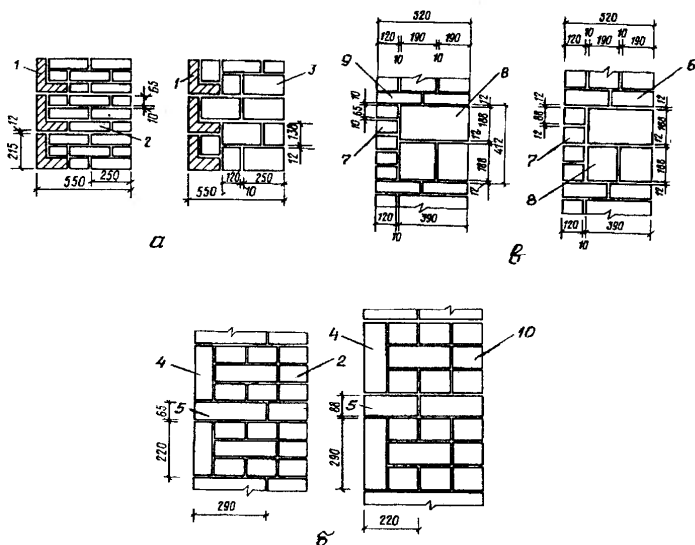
Облицовка фасадов каменных стен зданий: а – Г-образными закладными бетонными плитами; б – плоскими бетонными плитами; в – стен из бетонных камней; 1 – закладные бетонные плиты; 2 – кладка из кирпича толщиной 65 мм; 3 – кладка из керамических камней высотой 138 мм; 4 – плоские плиты; 5 – прокладной ряд из плит; 6 – кирпич толщиной 88 мм; 7 – лицевой кирпич; 8 – бетонный камень; 9 – прокладной тычковый ряд из кирпича толщиной 65 мм; 10 – прокладной тычковый ряд из кирпича толщиной 88 мм
